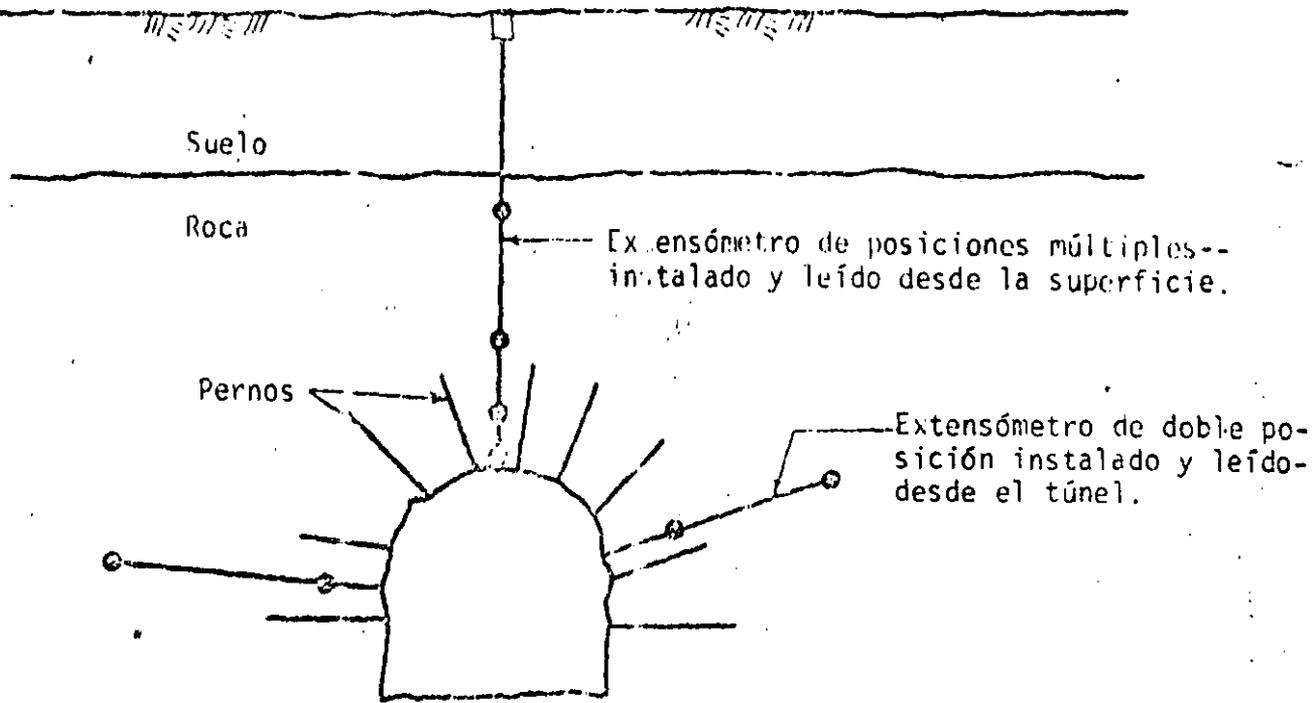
A. Instrumentación de un túnel somero en roca, ademado con pernos
